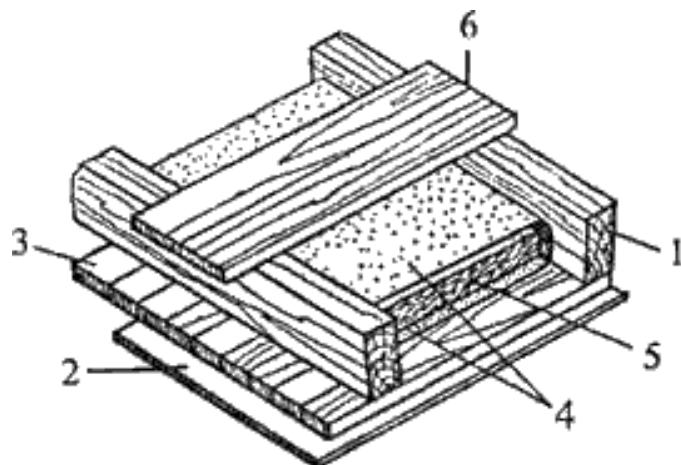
Чердачное перекрытие: 1 — балки; 2 — подшивка потолка; 3 — настил из необрезных досок; 4 — пергамин; 5 — утеплитель (минераловатные плиты); 6 — ходовая доска.
